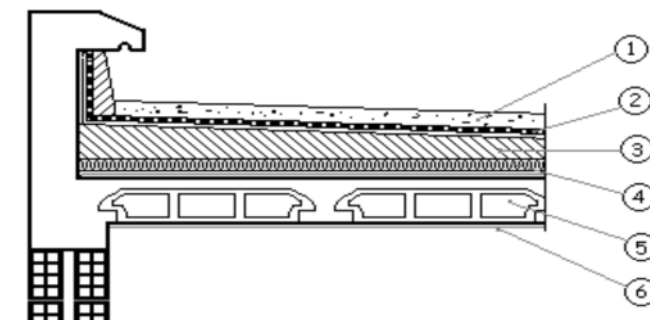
Coupe verticale du dernier plancher (terrasse).
